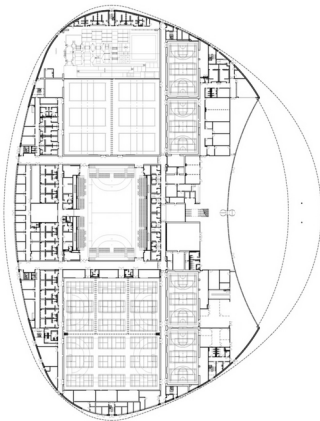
Plan przyziemia. Wejście główne do budynku.
